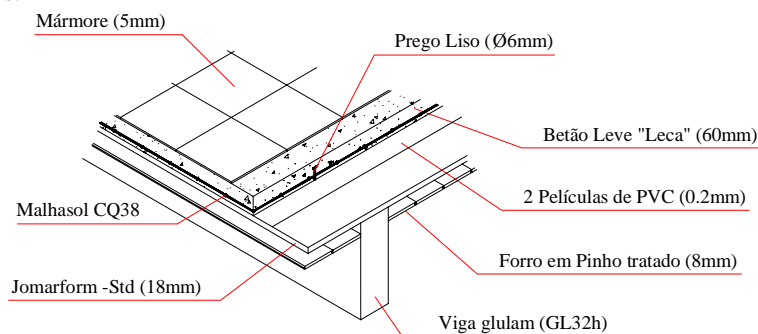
Solução mista madeira-betão leve escolhida para os pavimentos sob as instalações sanitárias
